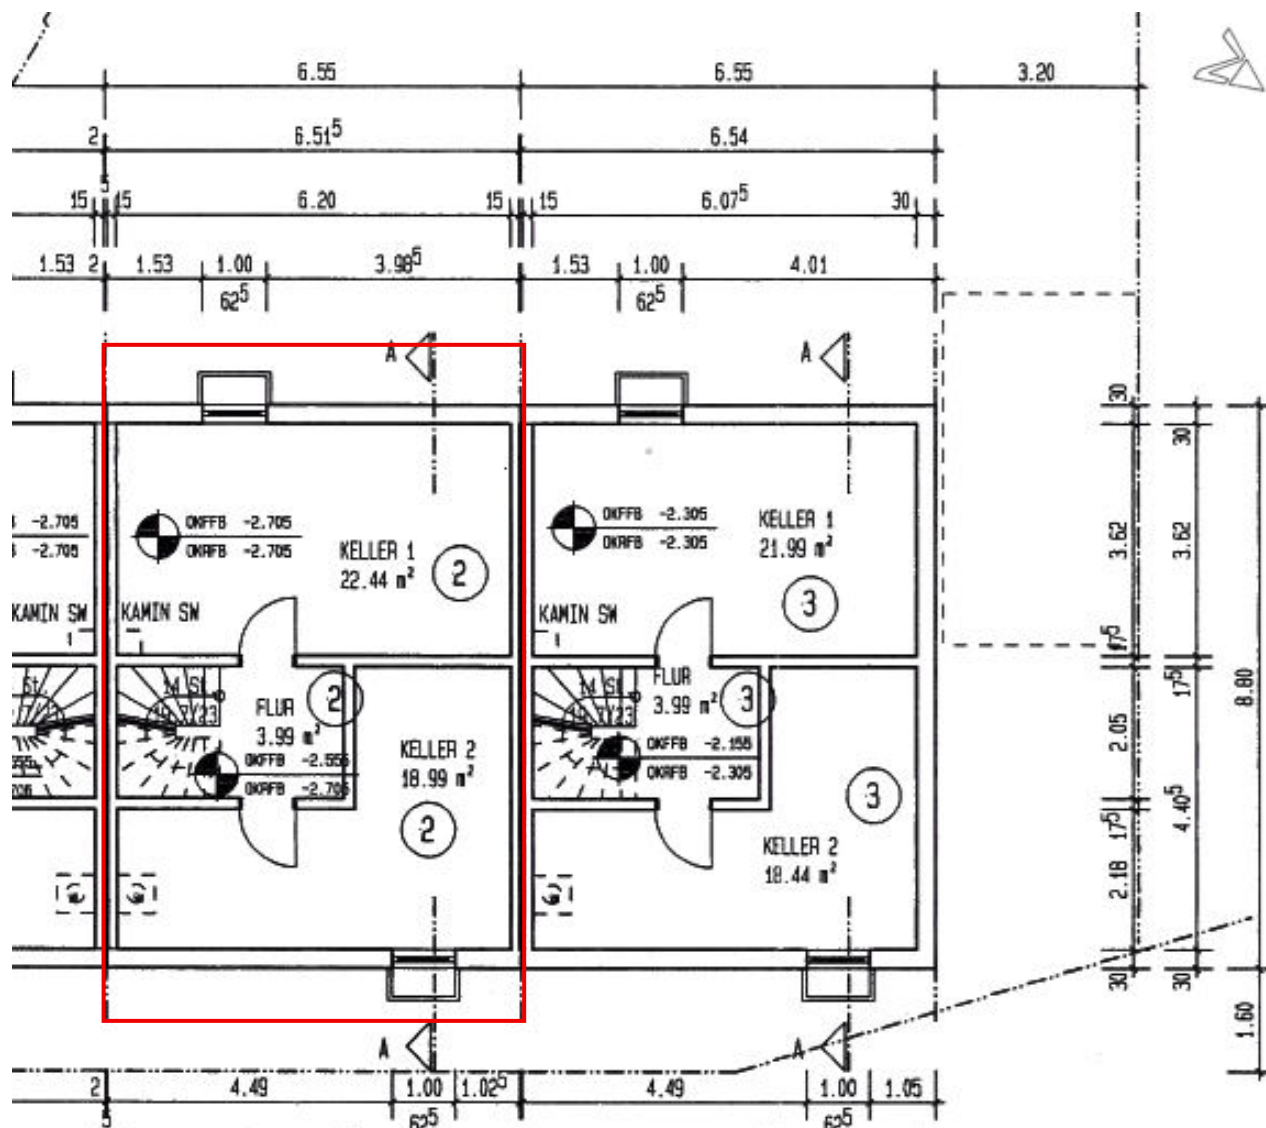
Grundriss Kellergeschoss (Ausschnitt ohne Maßstab); Detail Sondereigentum Nr. 2; Quelle: Bauakte; Roteintragung durch den SV
